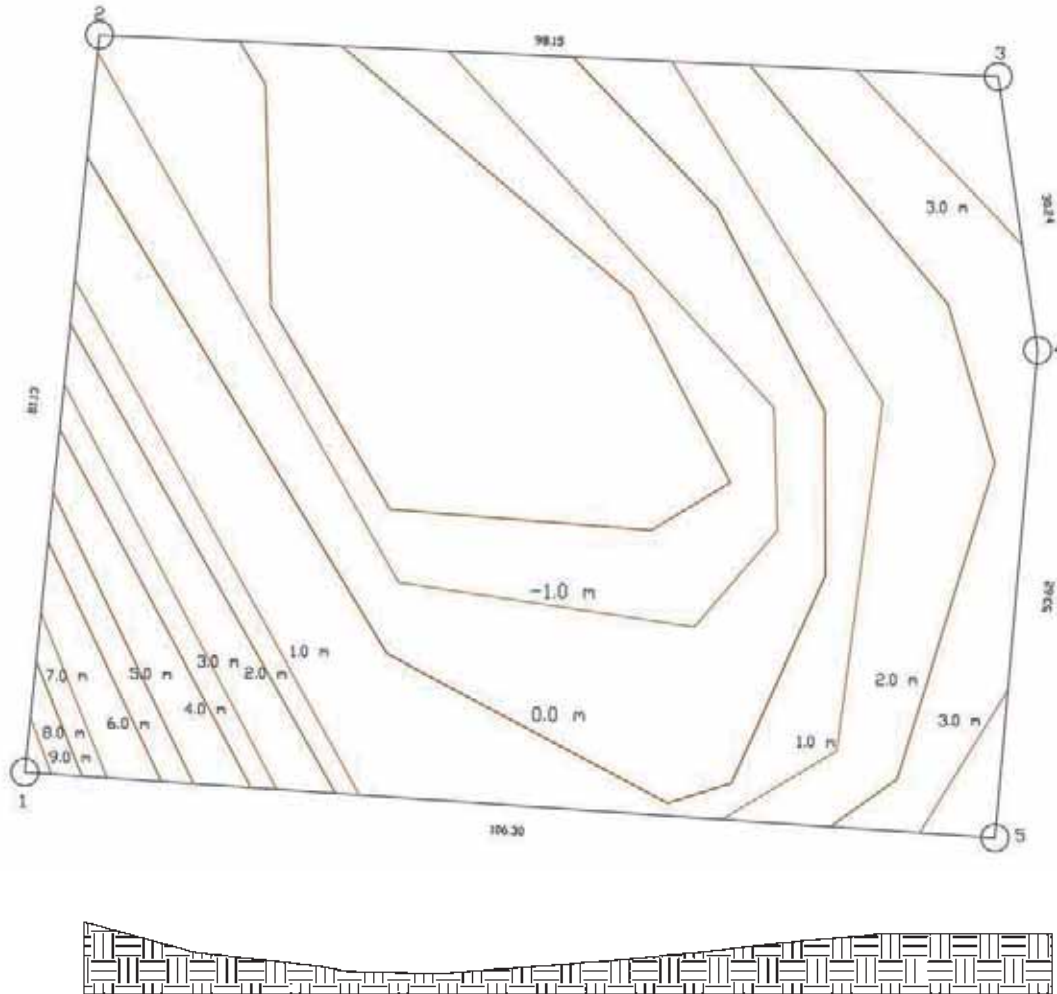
Topografía del predio. Fuente: Autoría propia.
